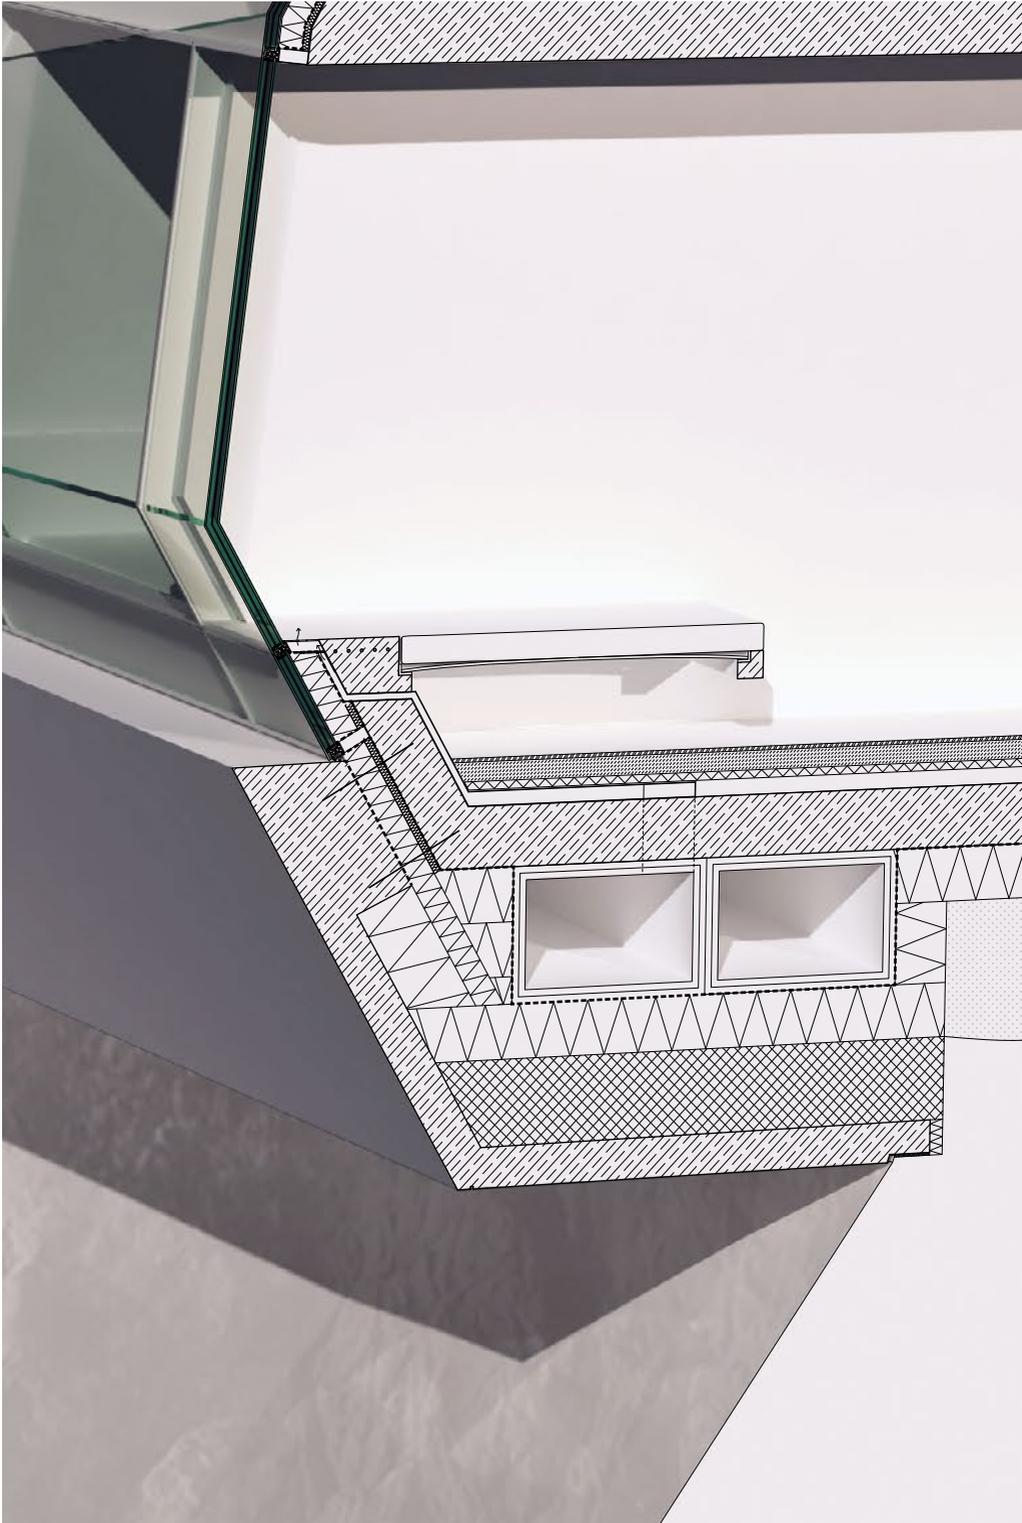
| Detailfassadenschnitt Ebene -6,4m
